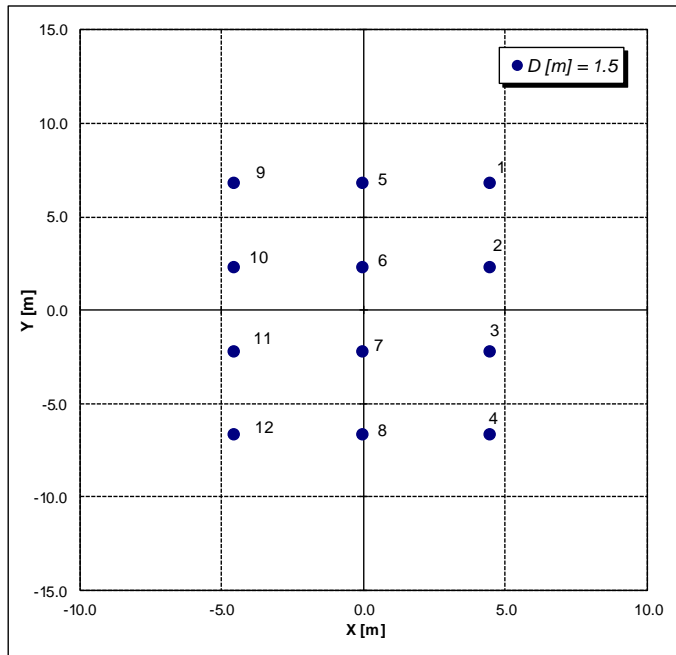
Fattori di riduzione per effetto gruppo orizzontale – spalla B fondazione a 12 pali
